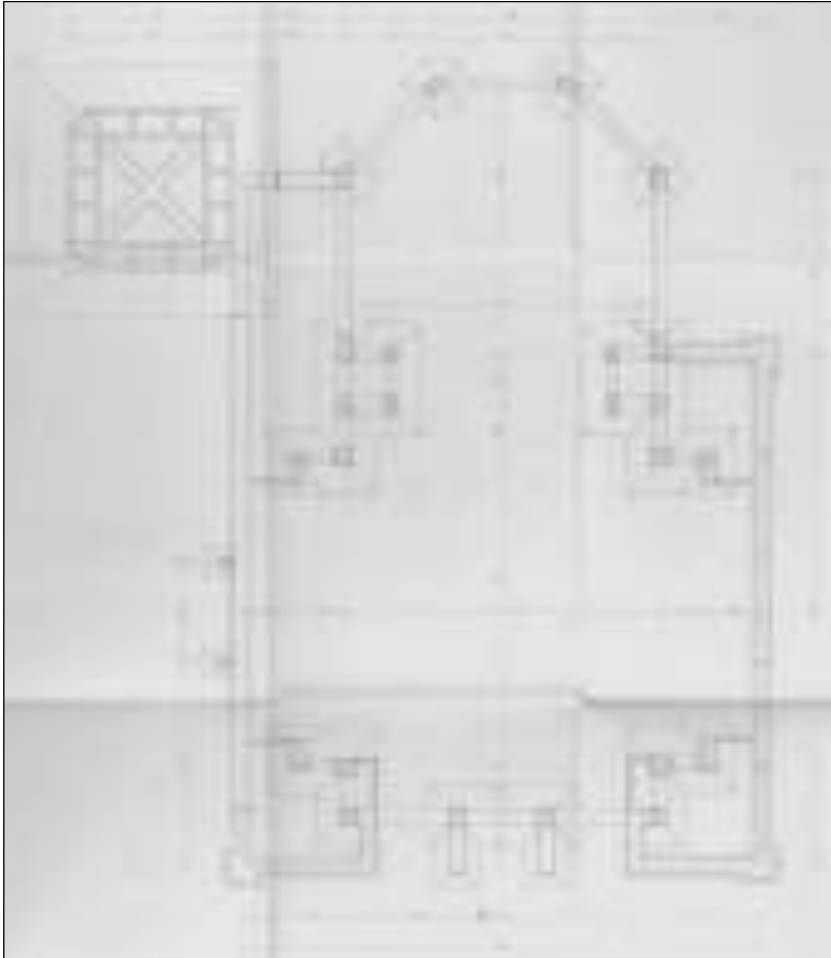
Borgo di Policoro (MT): pianta delle fondazioni della chiesa - Archivio ERSAP
